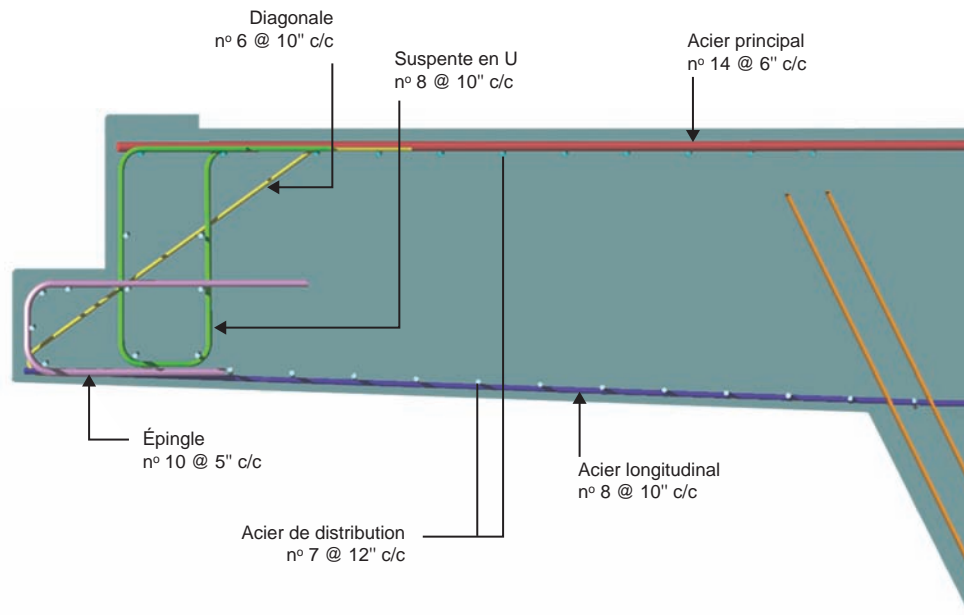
Disposition des barres d'armature spécifiées sur les plans dans le porte-à-faux de la culée est
